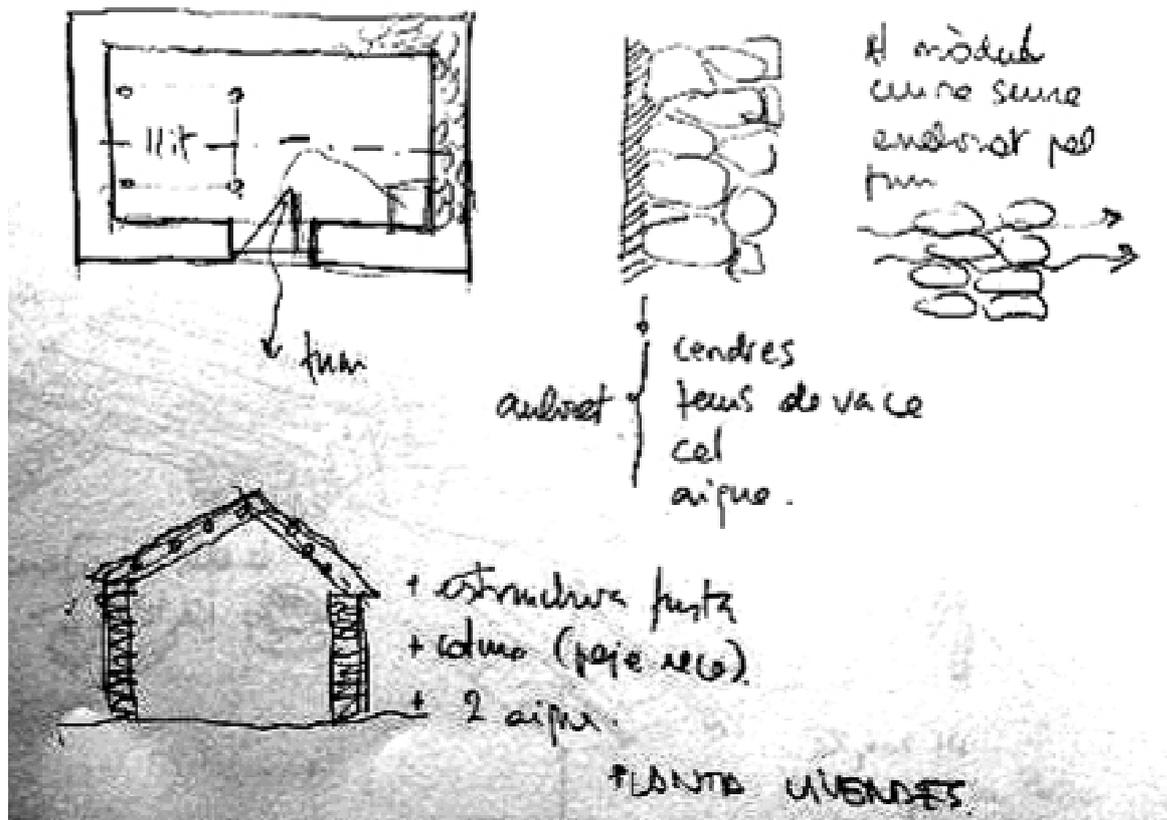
Croquis "PLANTA VIVIENDA" / La pequeña planta es rectangular con muro de carga revocado con una mezcla de ceniza, excremento de vaca, cal y agua. Cubierta a dos aguas con viguetas de madera y colmo (paja de centeno seca). No tiene chimenea, el humo sale por tres sitios: la puerta, el "colmo" y el muro de cocina que no se revoca. (Miguel 2013)
